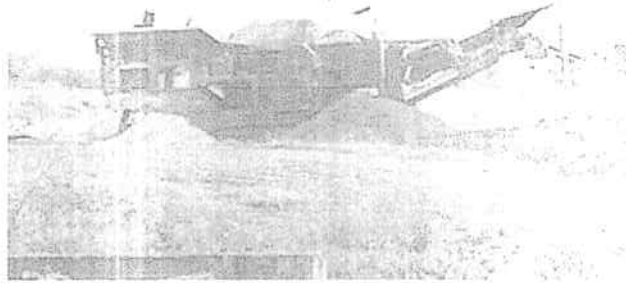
Planta móvil trituradora de piedra Canto Rodado sección Tolva 1 - Mandíbula.
